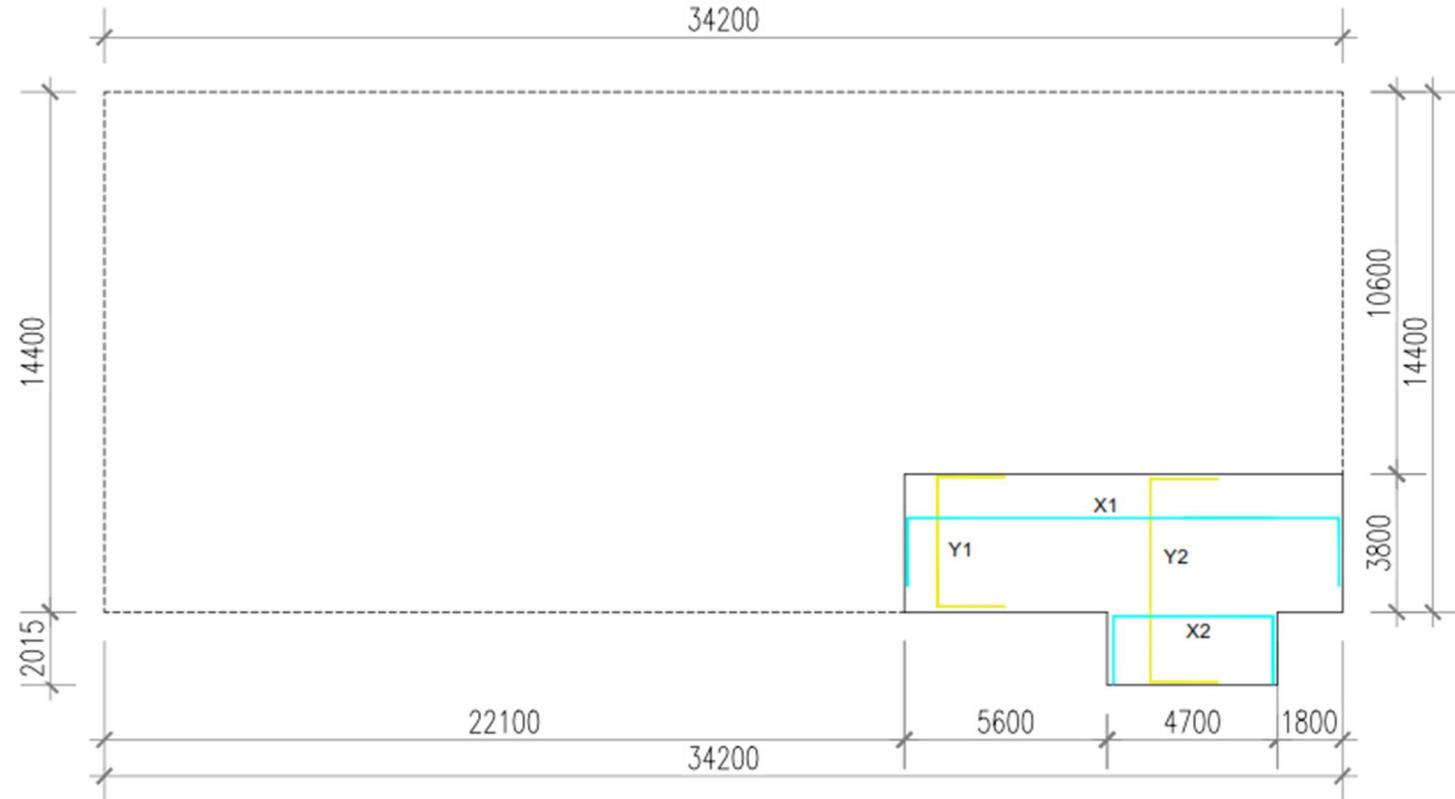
Layout tulangan atas +3.75 m (*top bar el.* +3.75 m)
